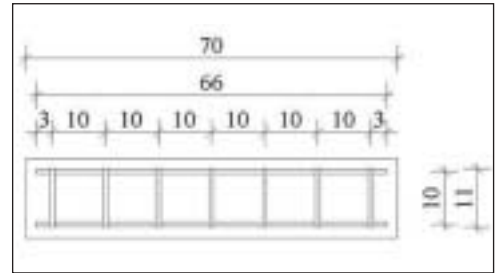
Anordnung der Bewehrung in den Betonbalken, Angaben in cm
